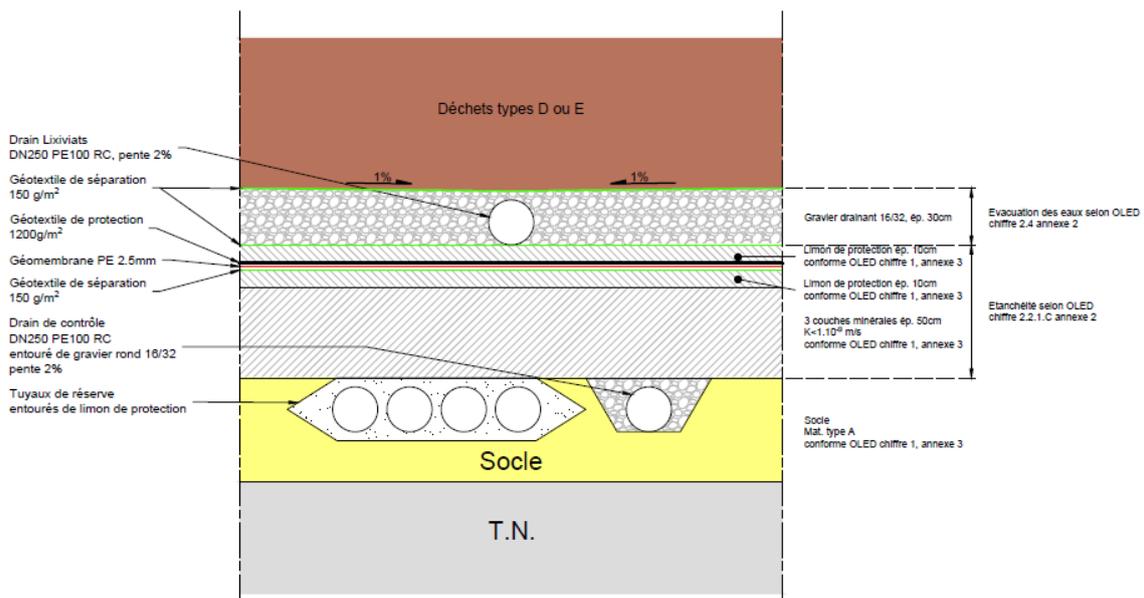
Etanchéité / drainage du fond de casier type D ou E
